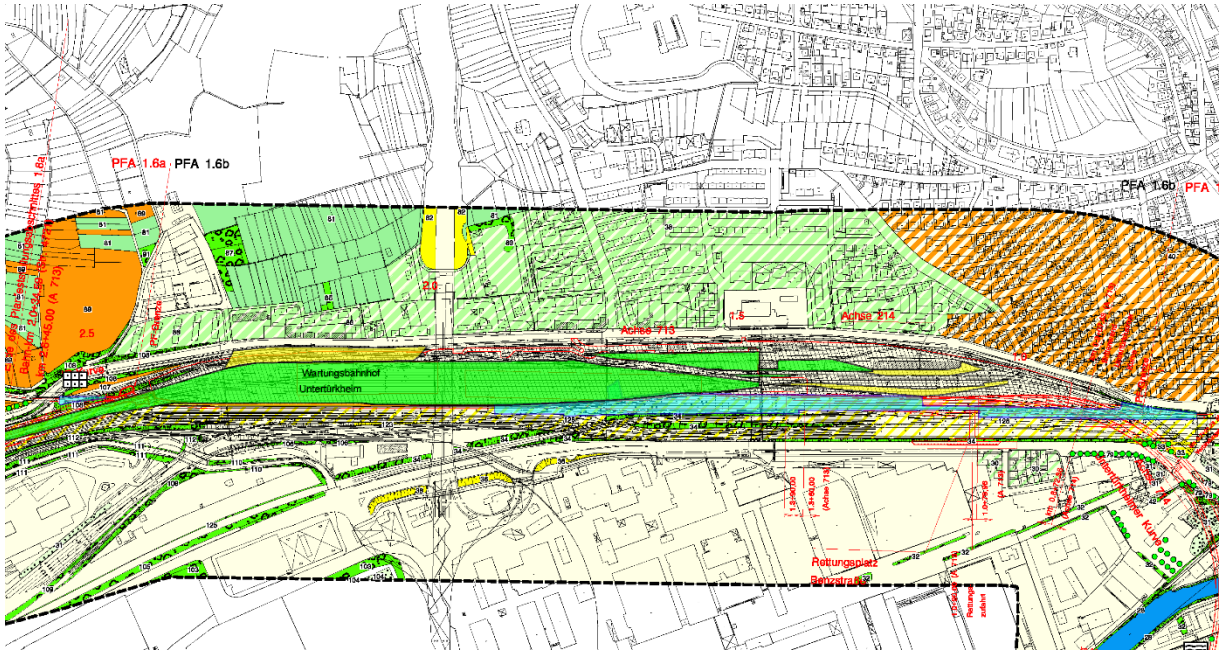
Ausschnitt Bestandsplan (Anlage 18.2.1.1, Blatt 2), geändert
